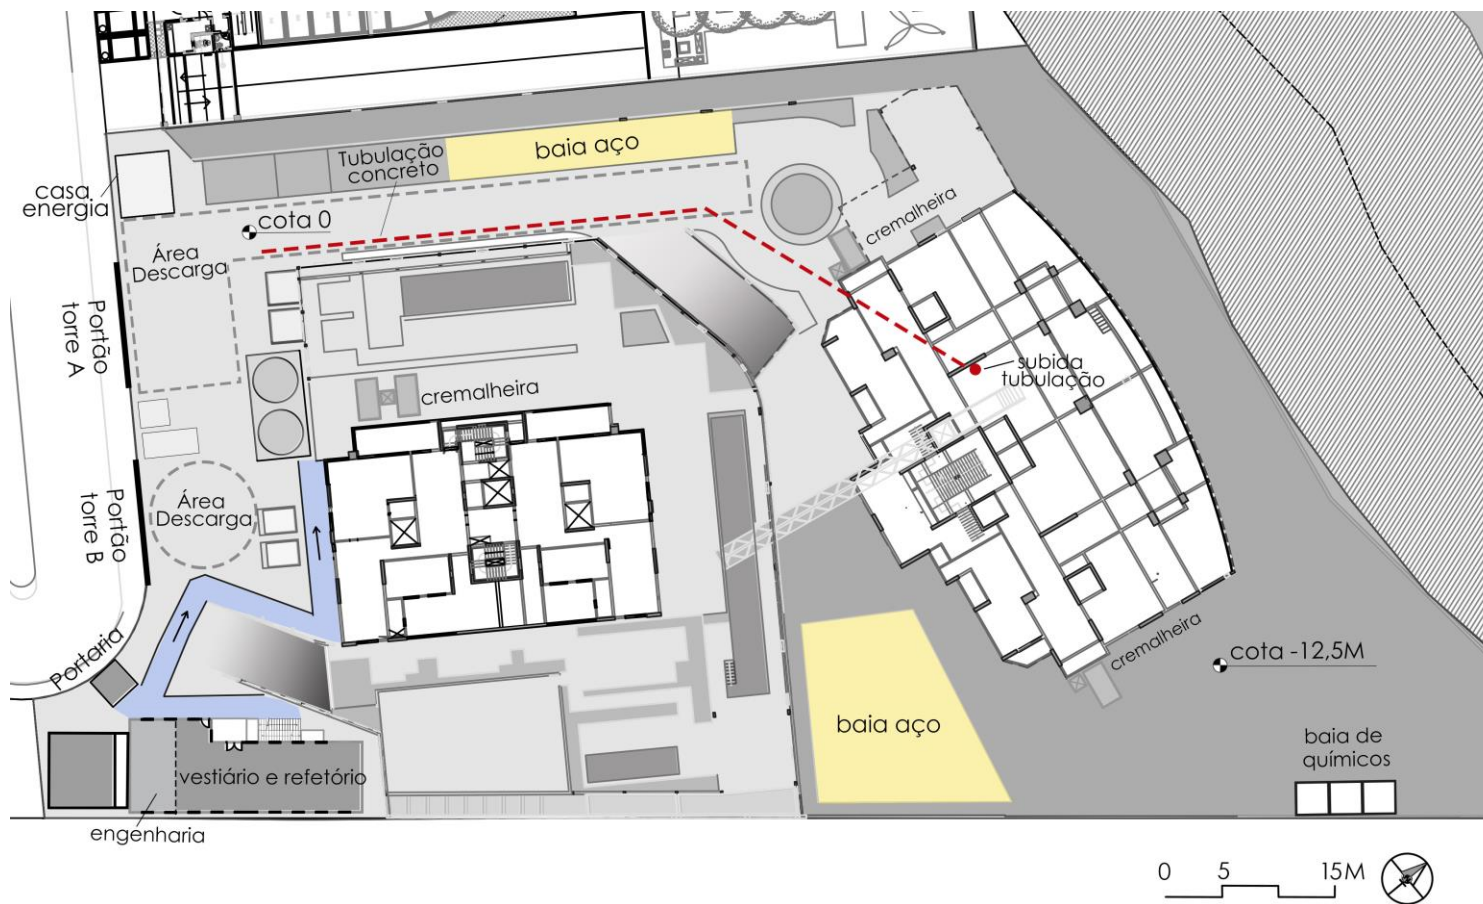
Layout do canteiro de obras após a conclusão dos setores 1 e 2 da torre “A”. Autor: Giovani Vespe.
